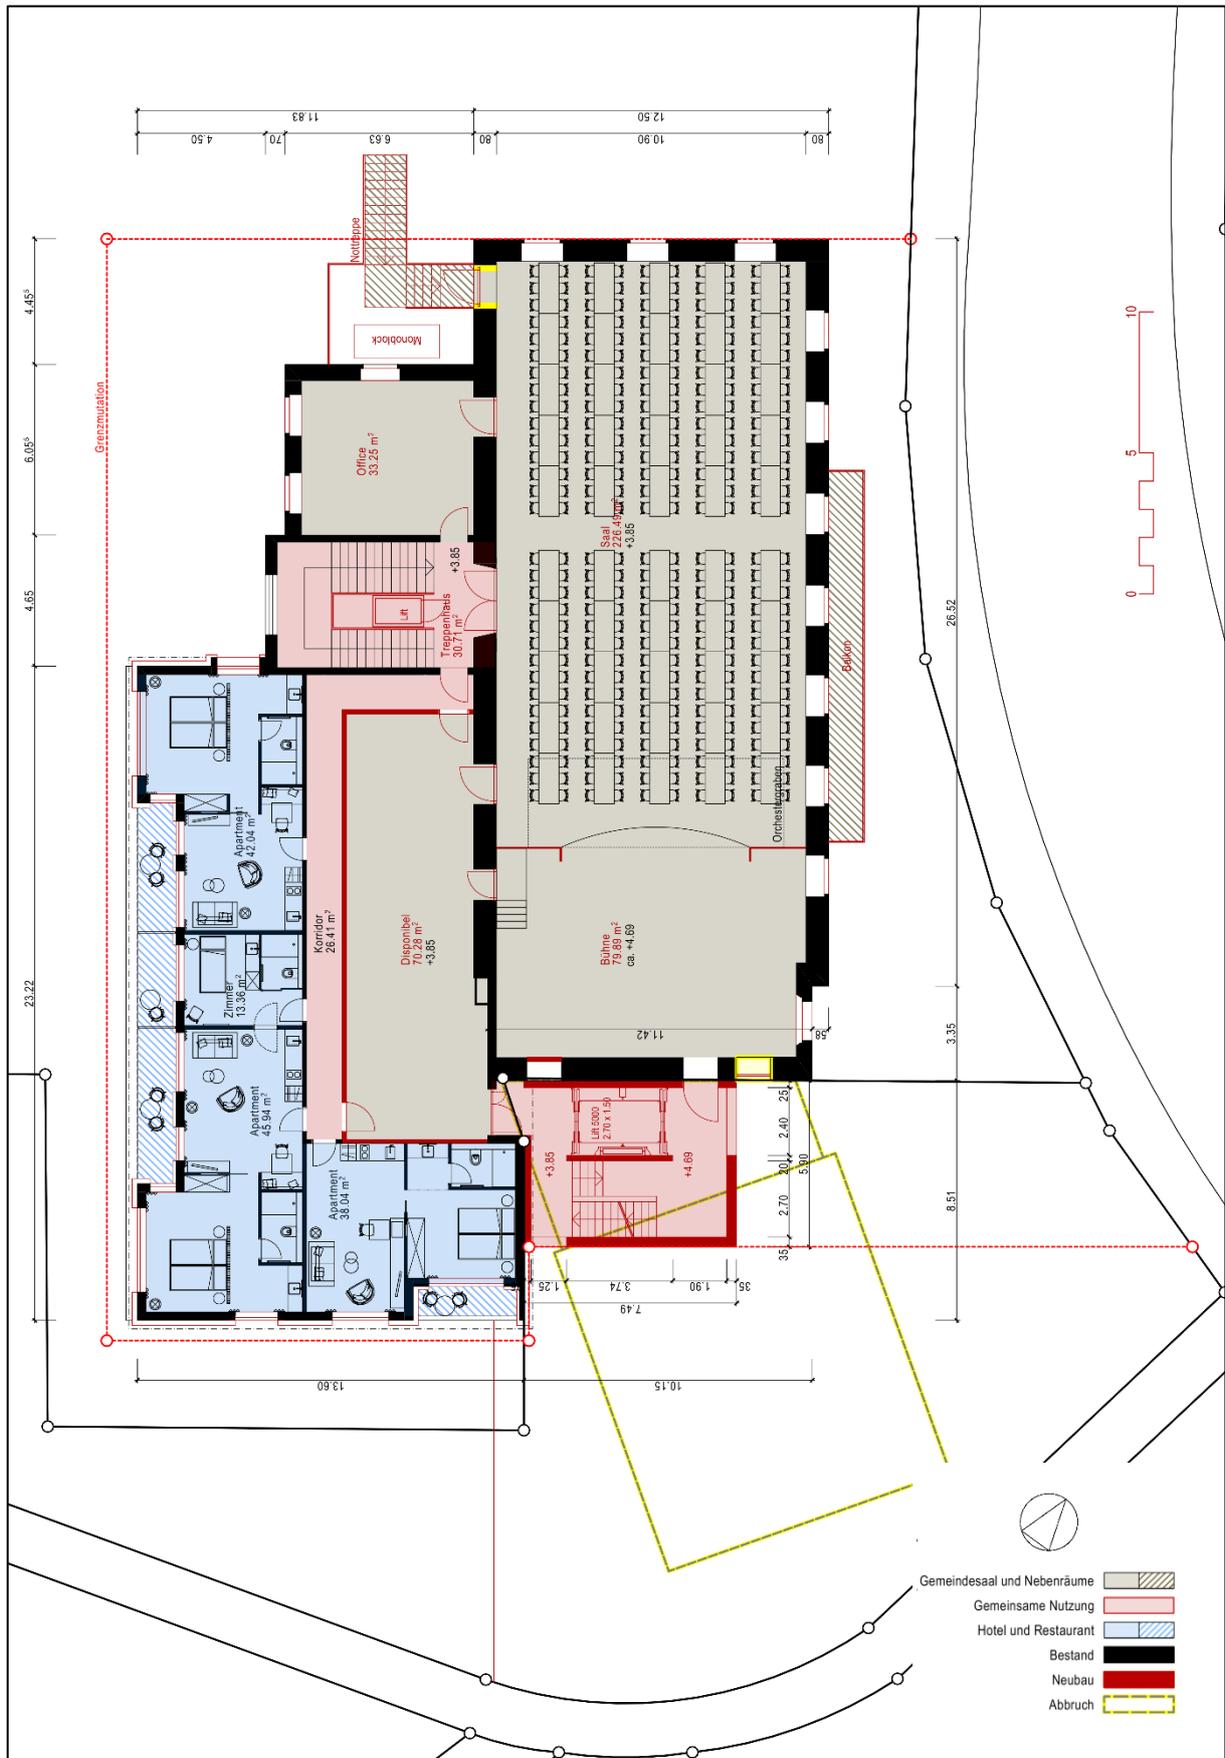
Grundriss 1. Obergeschoss, mit Distanzangabe, Stand: 3.11.2022
